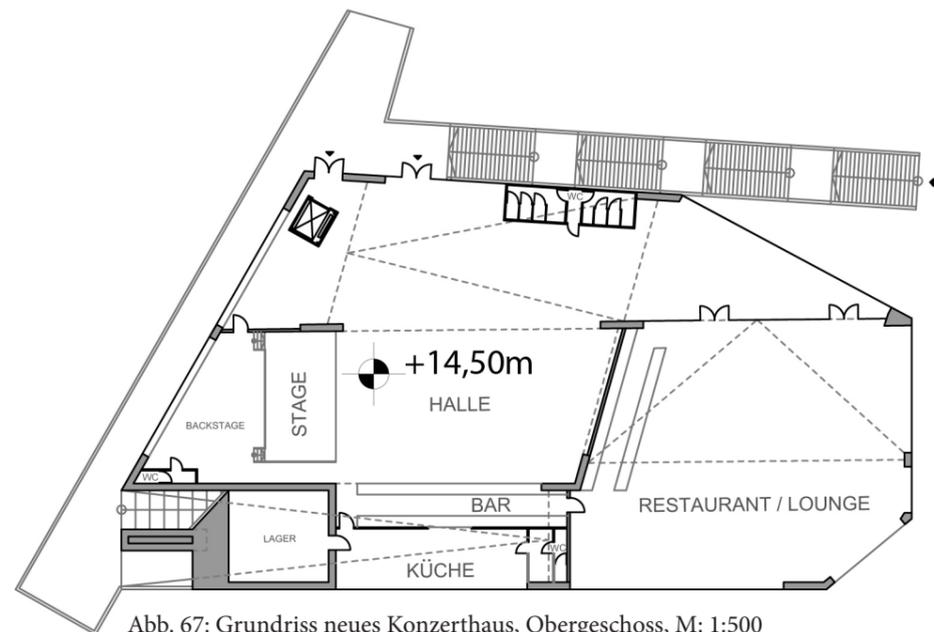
Grundriss neues Konzerthaus, Obergeschoss, M: 1:500
